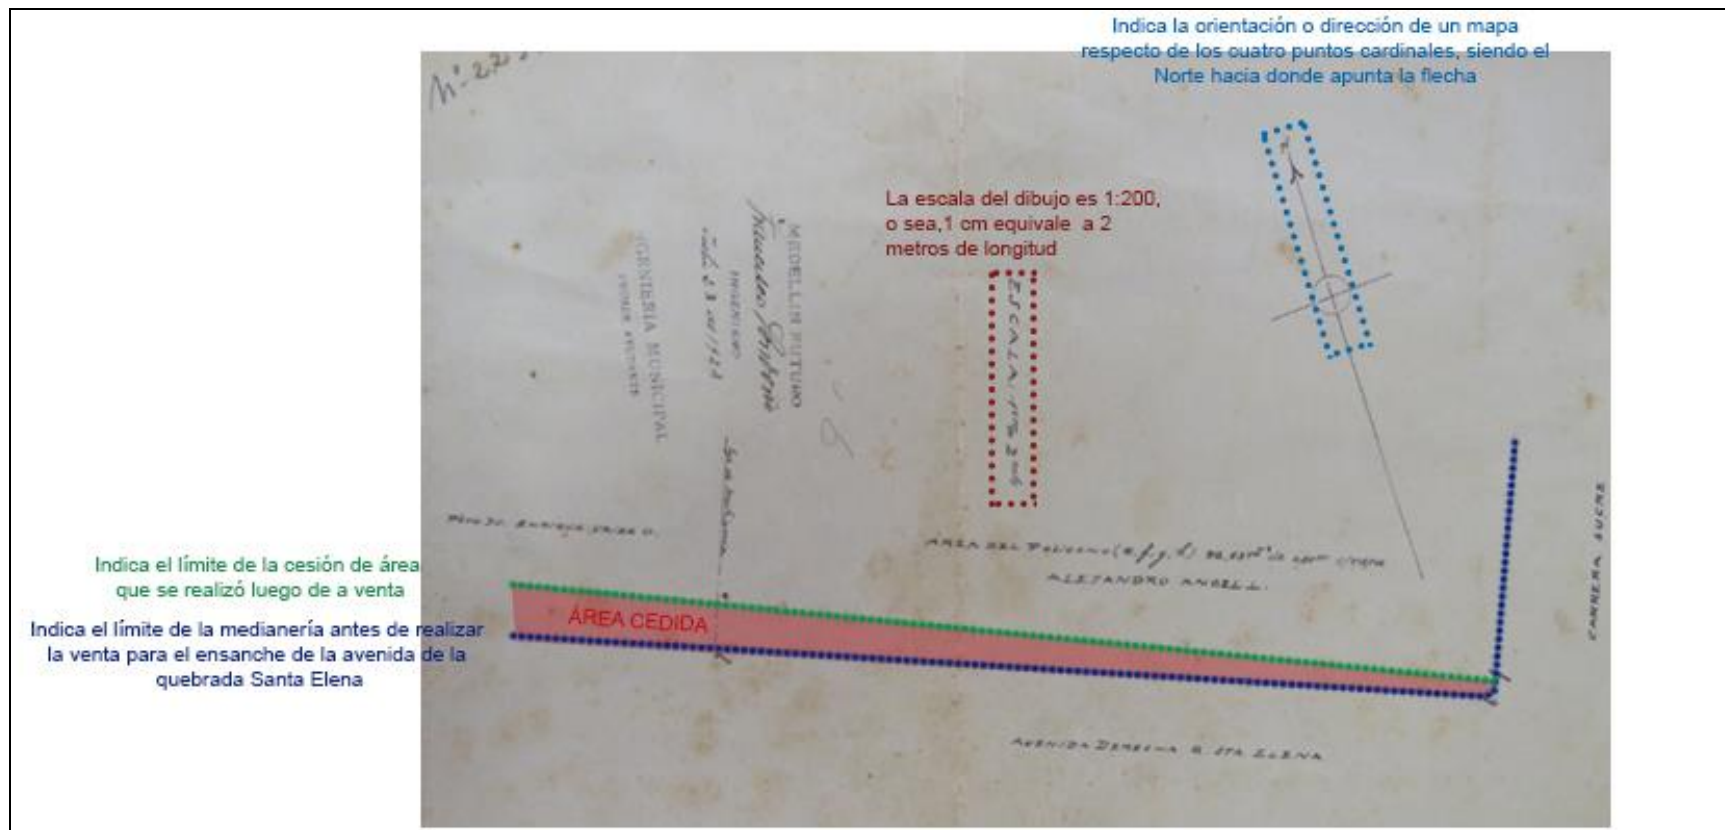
Avenida derecha de la quebrada Santa Elena, paralela hasta la calle Sucre
